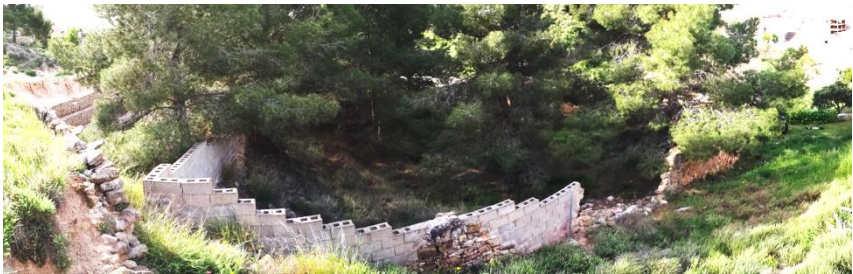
Fotografía estado actual vista exterior fachada Oeste. Fuente propia.
